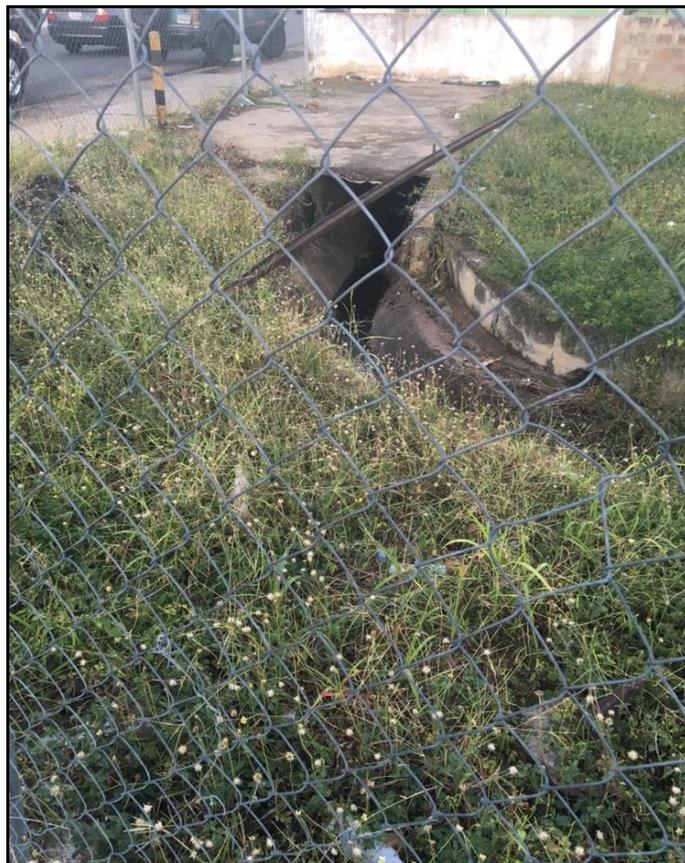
Parte del canal ubicado al frente de la Panadería Imperial.
